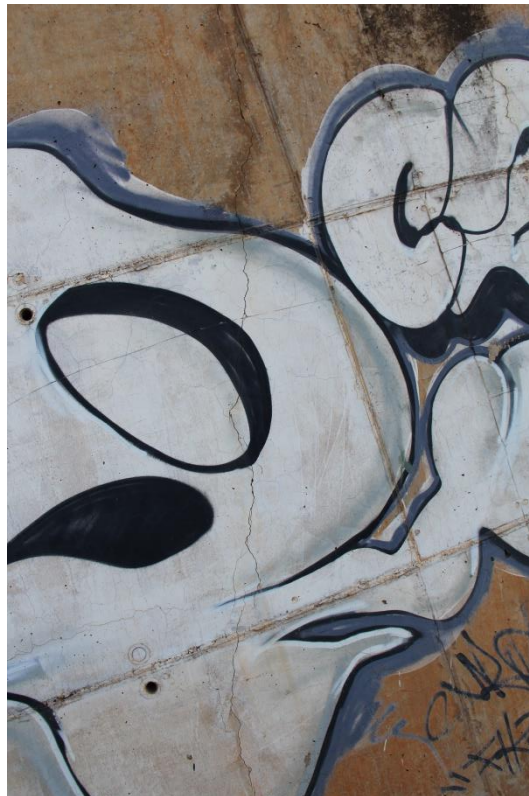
Fissuração Cortina Sul – Viaduto UnB Campus Gama
